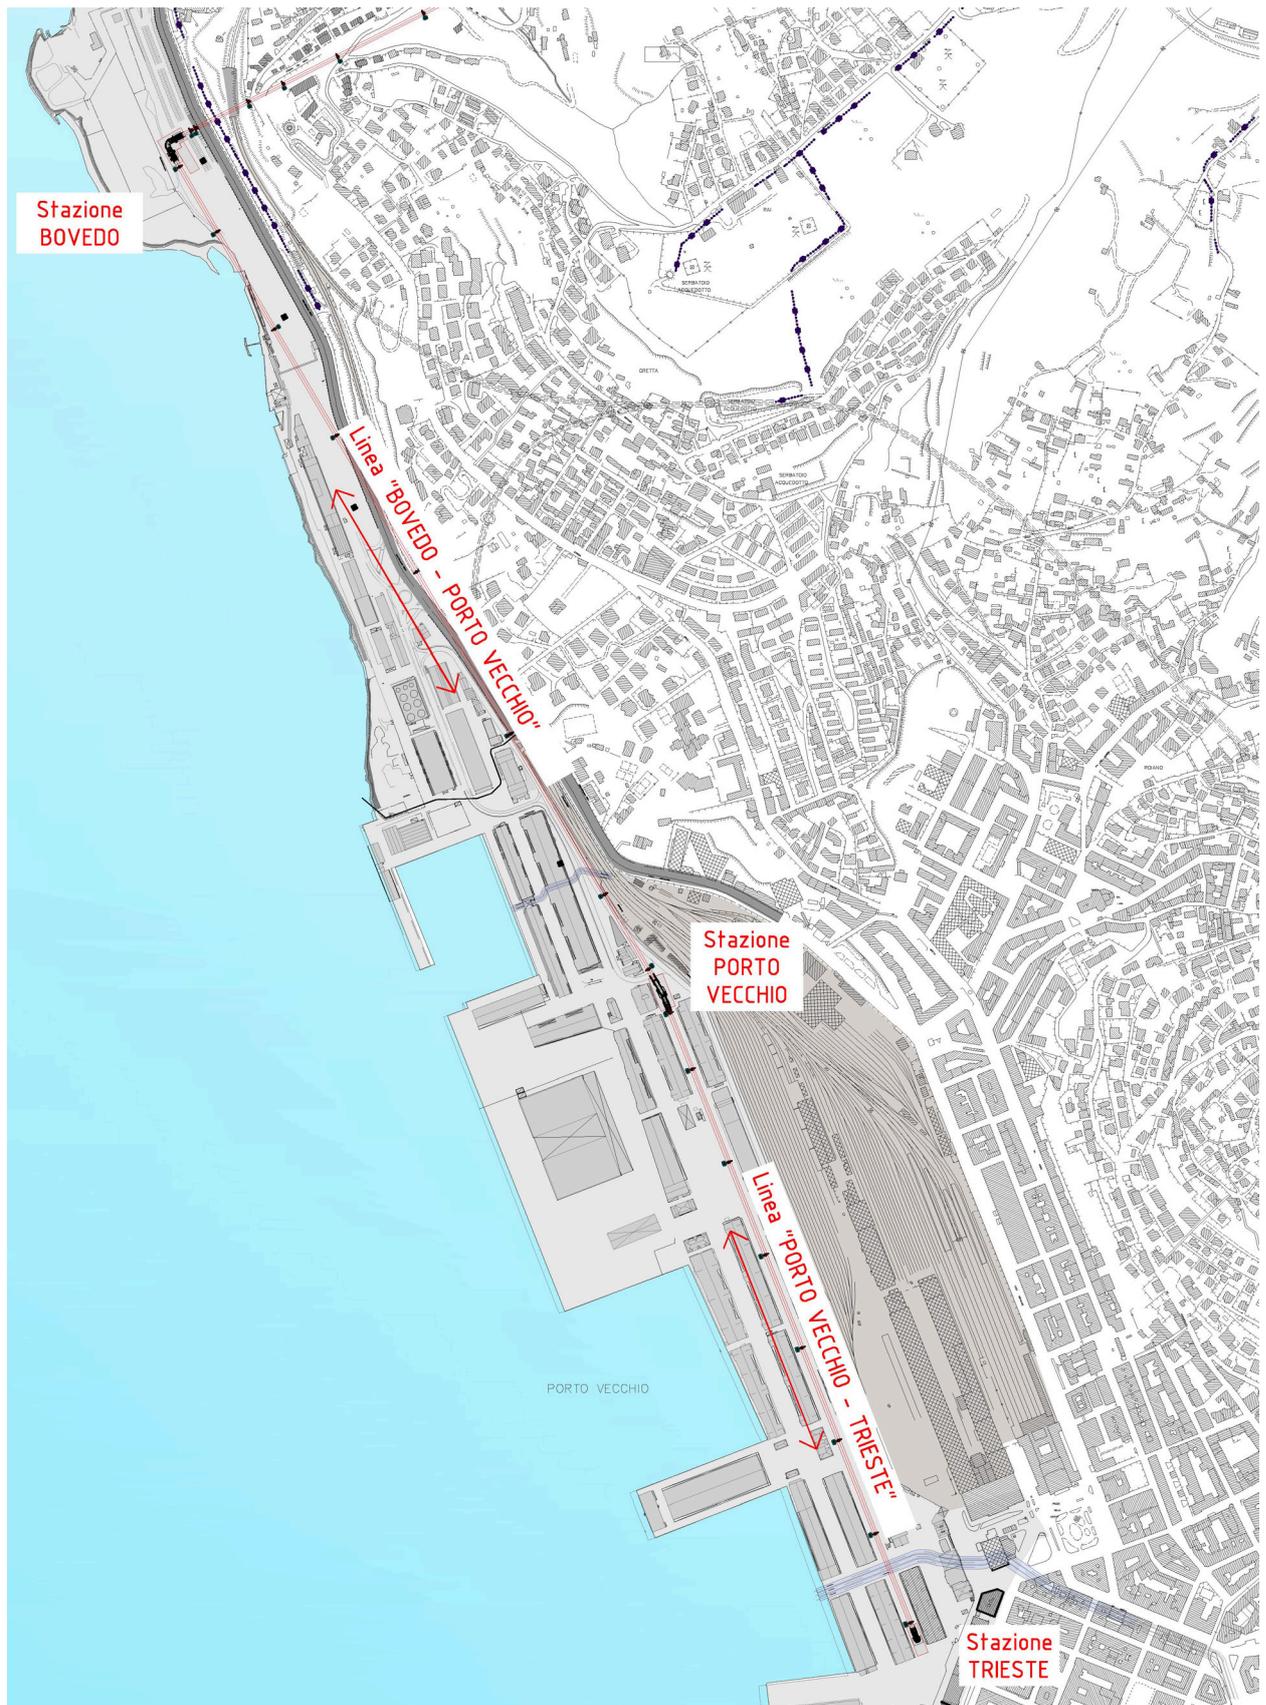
Tracciato planimetrico della linea "Bovedo - Porto Vecchio - Trieste".
